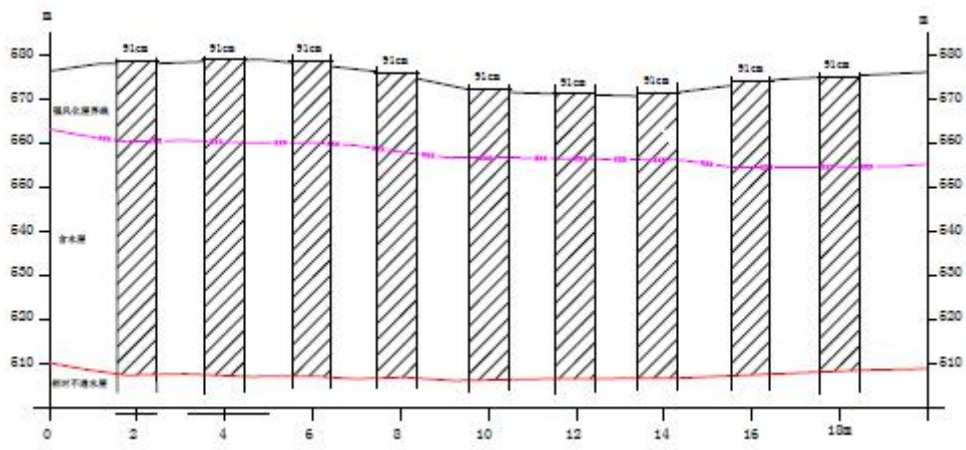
单位帷幕灌浆轴线展开平面示意图
